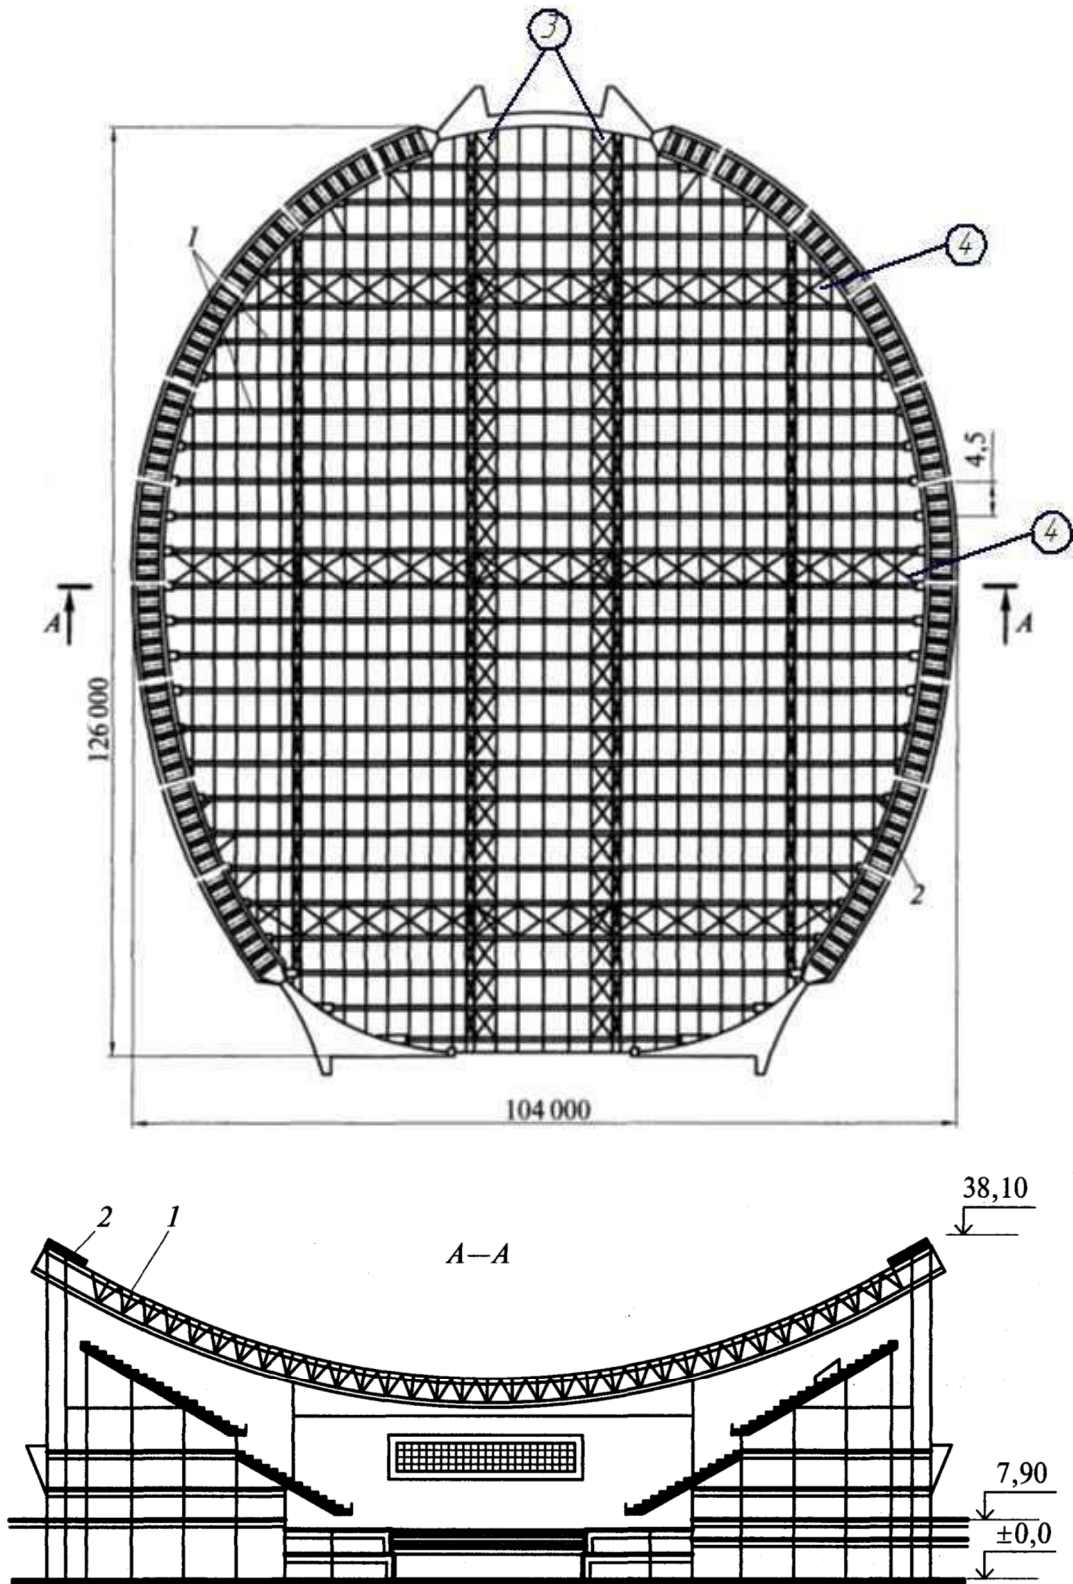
Покрытие изгибно-жесткими нитями (Олимпийский плавательный бассейн в г.Москве): 1 – висячие фермы; 2 – опорная конструкция; 3 – связи продольные; 4 – связи поперечные
